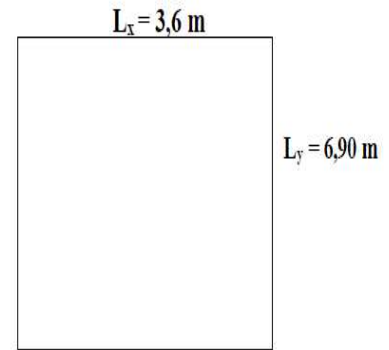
La section de plus grand Panneau de la dalle pleine de sous-sol (parking).
